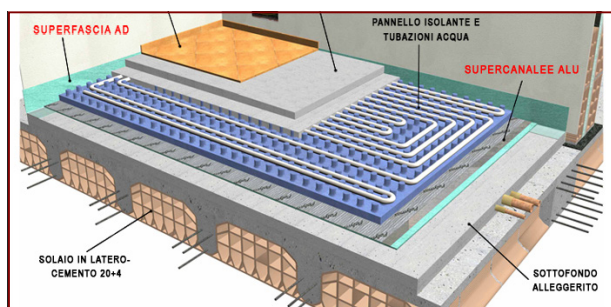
Esempio di pavimento radiante su un solaio in latero-cemento.
